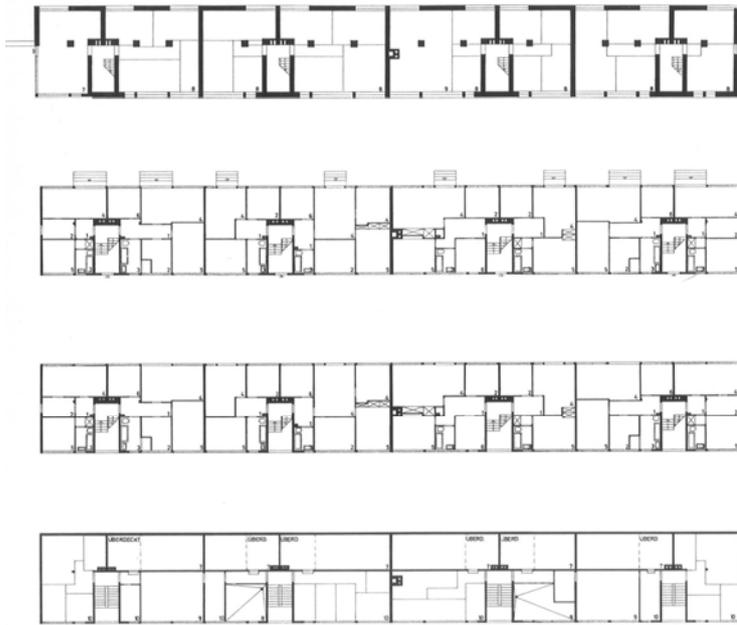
Grundriss Am Weißenhof 14 bis 20, Arch. Mies van der Rohe
